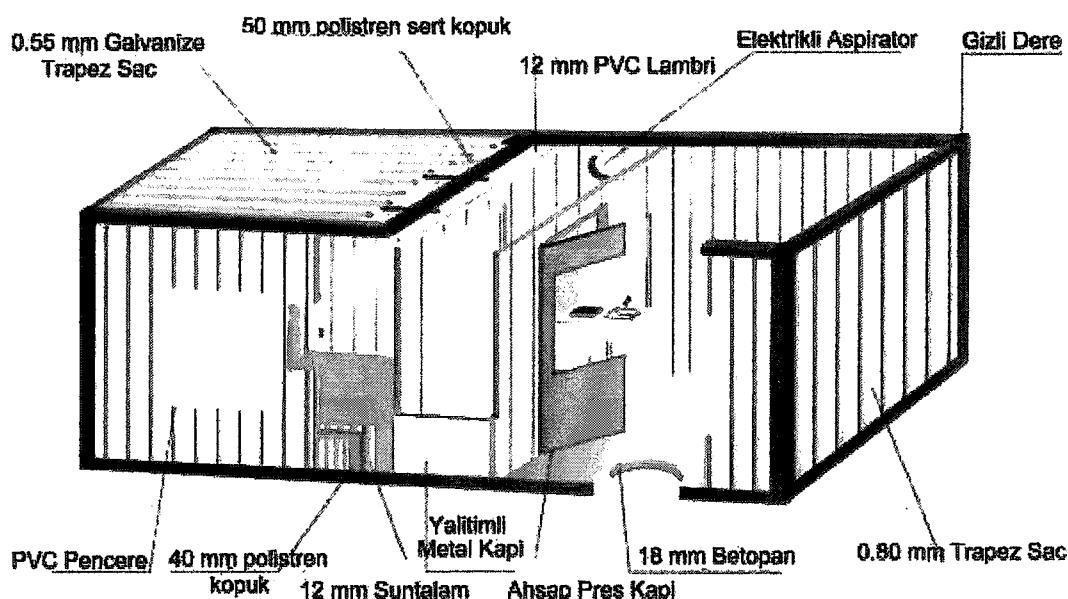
Uygulanan ilk tip konteynerin planı (Prefabrik Yapı, s.66)
